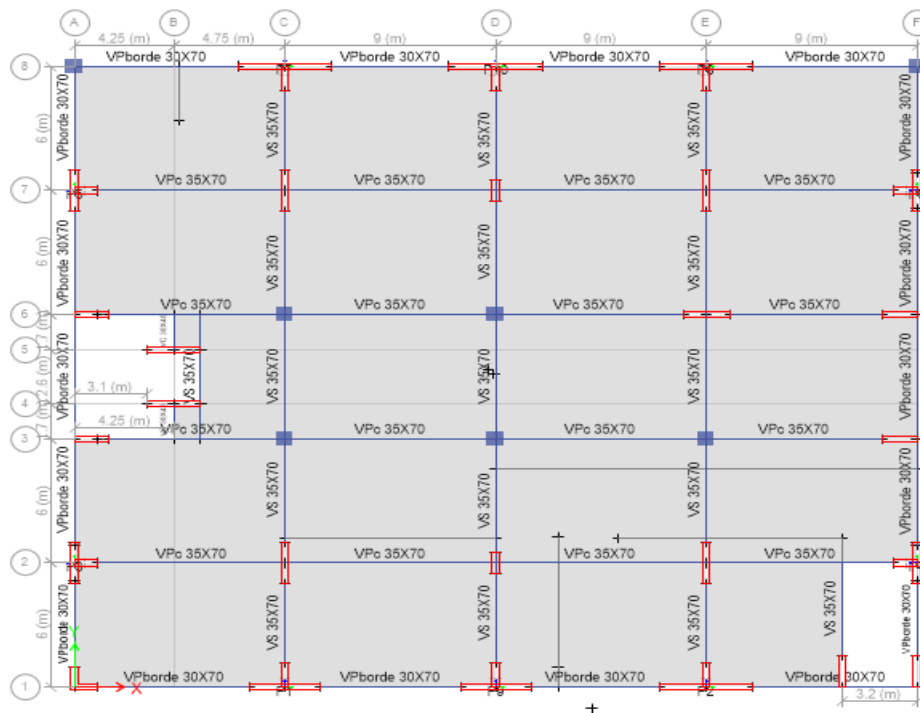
Sistema estructural Dual – Muros Estructurales. (Fuente Propia).
